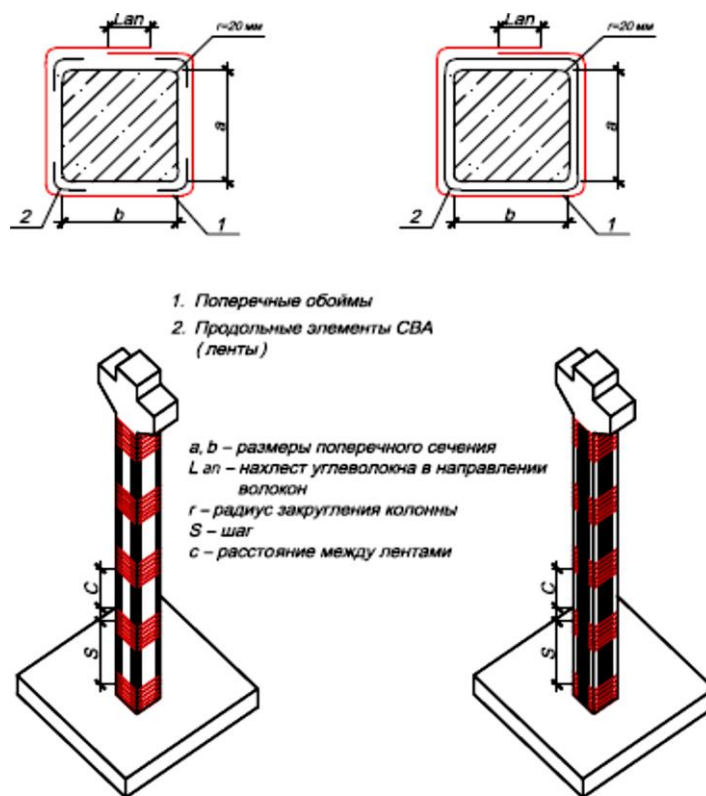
Усиление железобетонных колонн композитными материалами (холстами)
